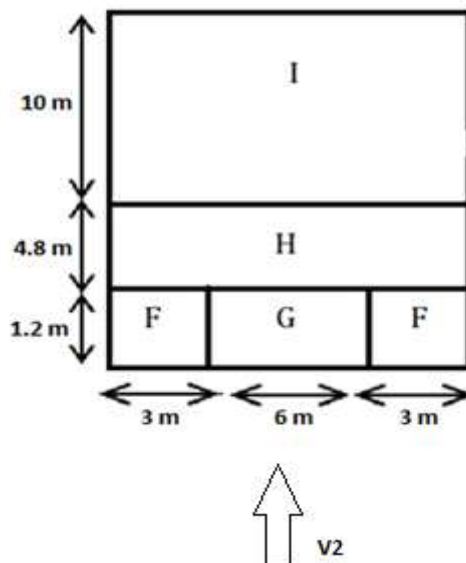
Vue en plan des zones de pression sur les parois verticales
